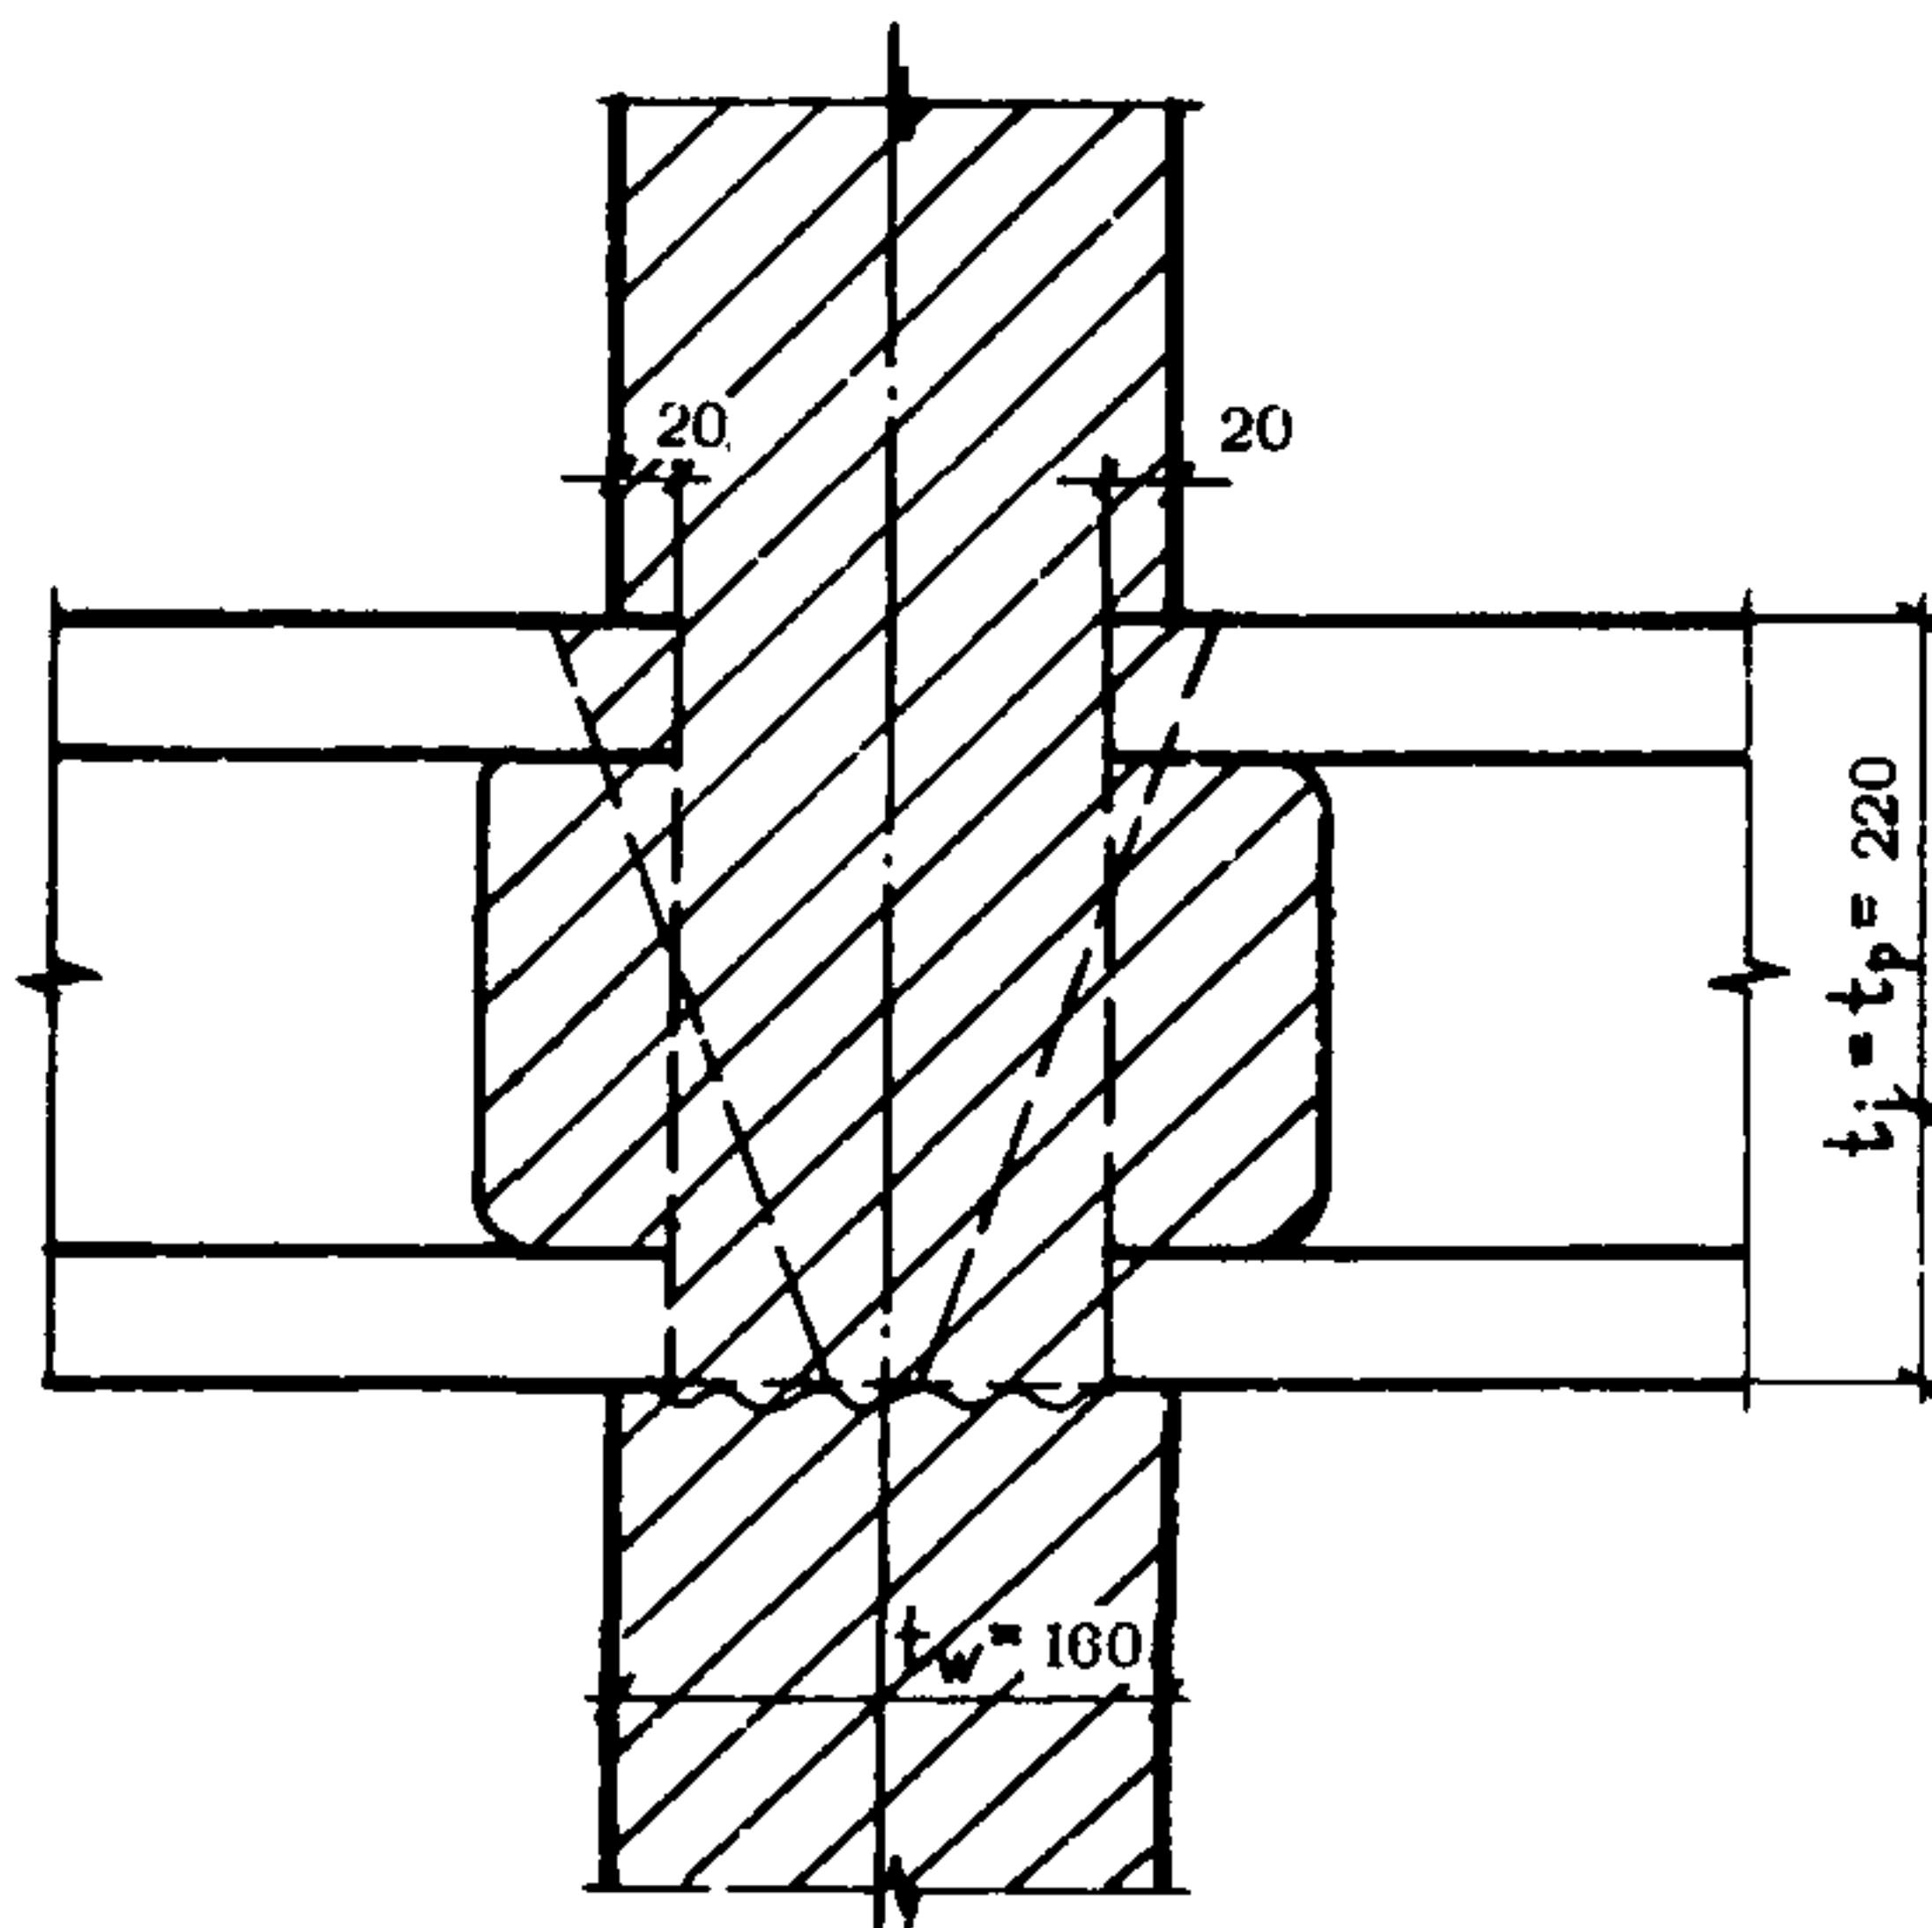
Стык монолитной стены с плитами перекрытий, опертыми на две стороны (к примеру 6)
